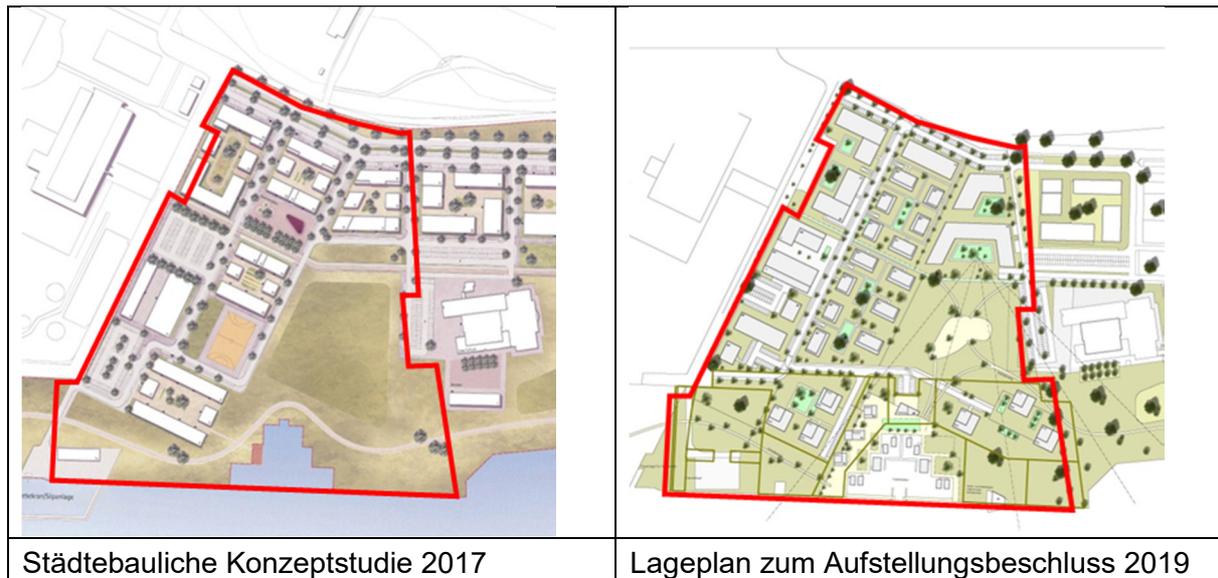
Planungsvarianten Konzeptstudie 2017 und Lageplan Aufstellungsbeschluss 2019
